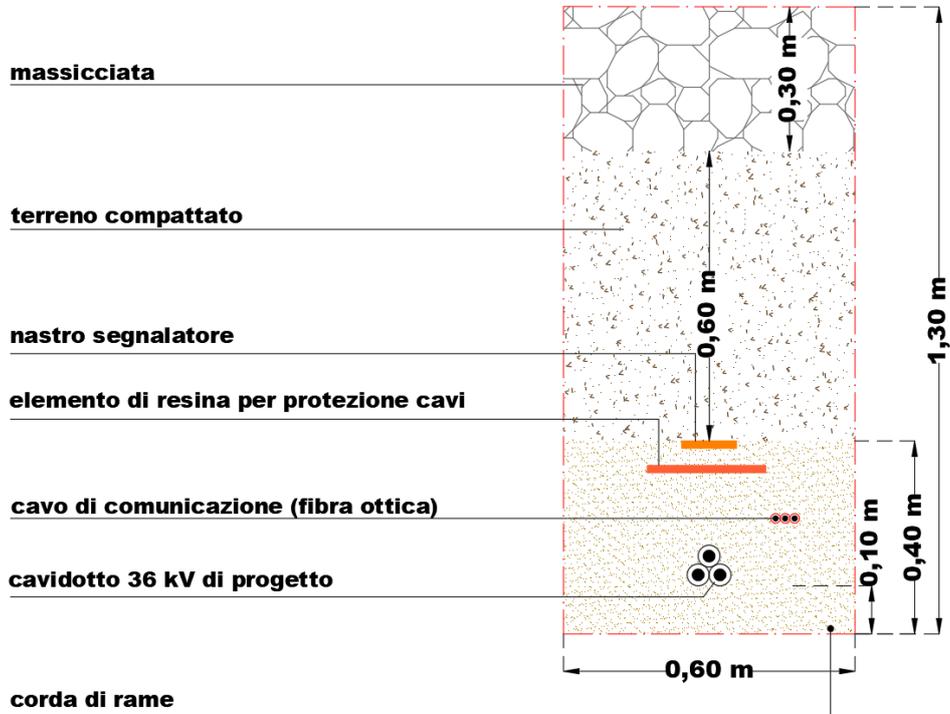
Sezione Cavidotto Singola Terna su Strada Bianca
